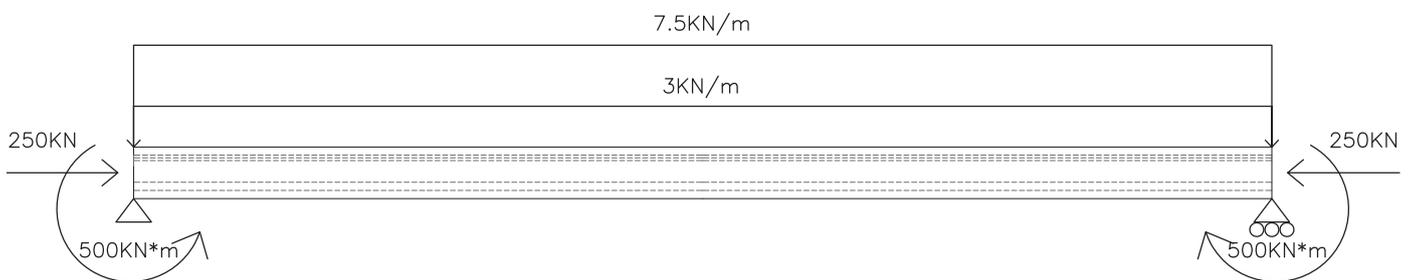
Viga con sus respectivas cargas además de las fuerzas de postesado.
